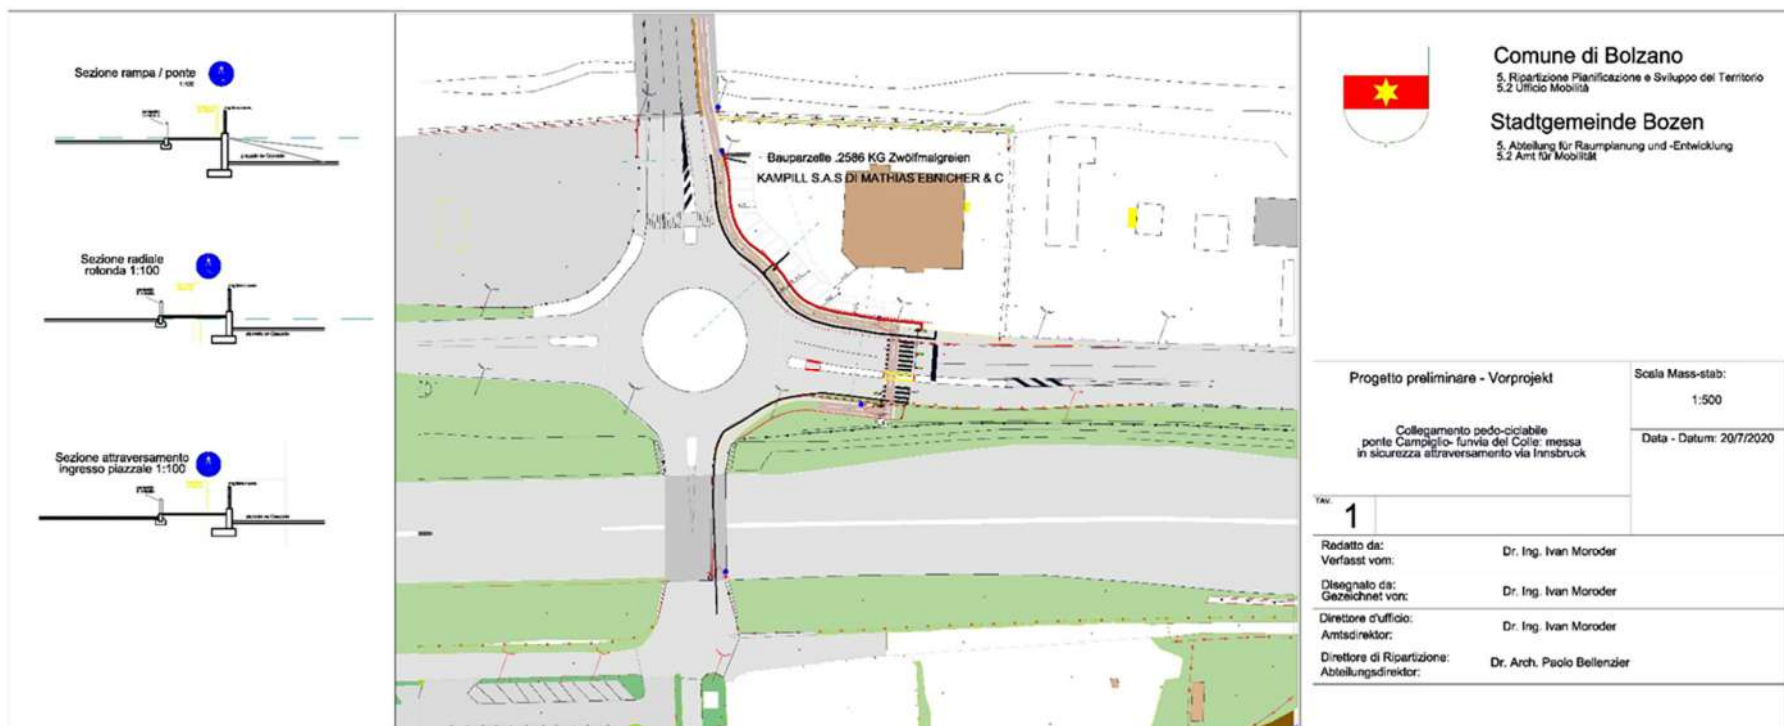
Ciclabile rotonda Campiglio - via Innsbruck (9) - Planimetria di progetto
